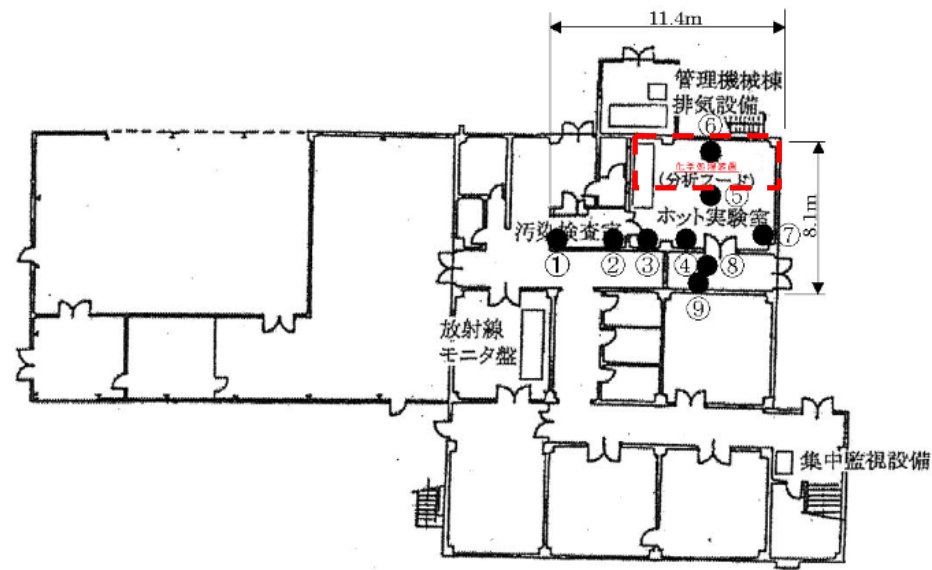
β・γ 固体処理棟Ⅲ (2階) 平面図及び可燃物配置
